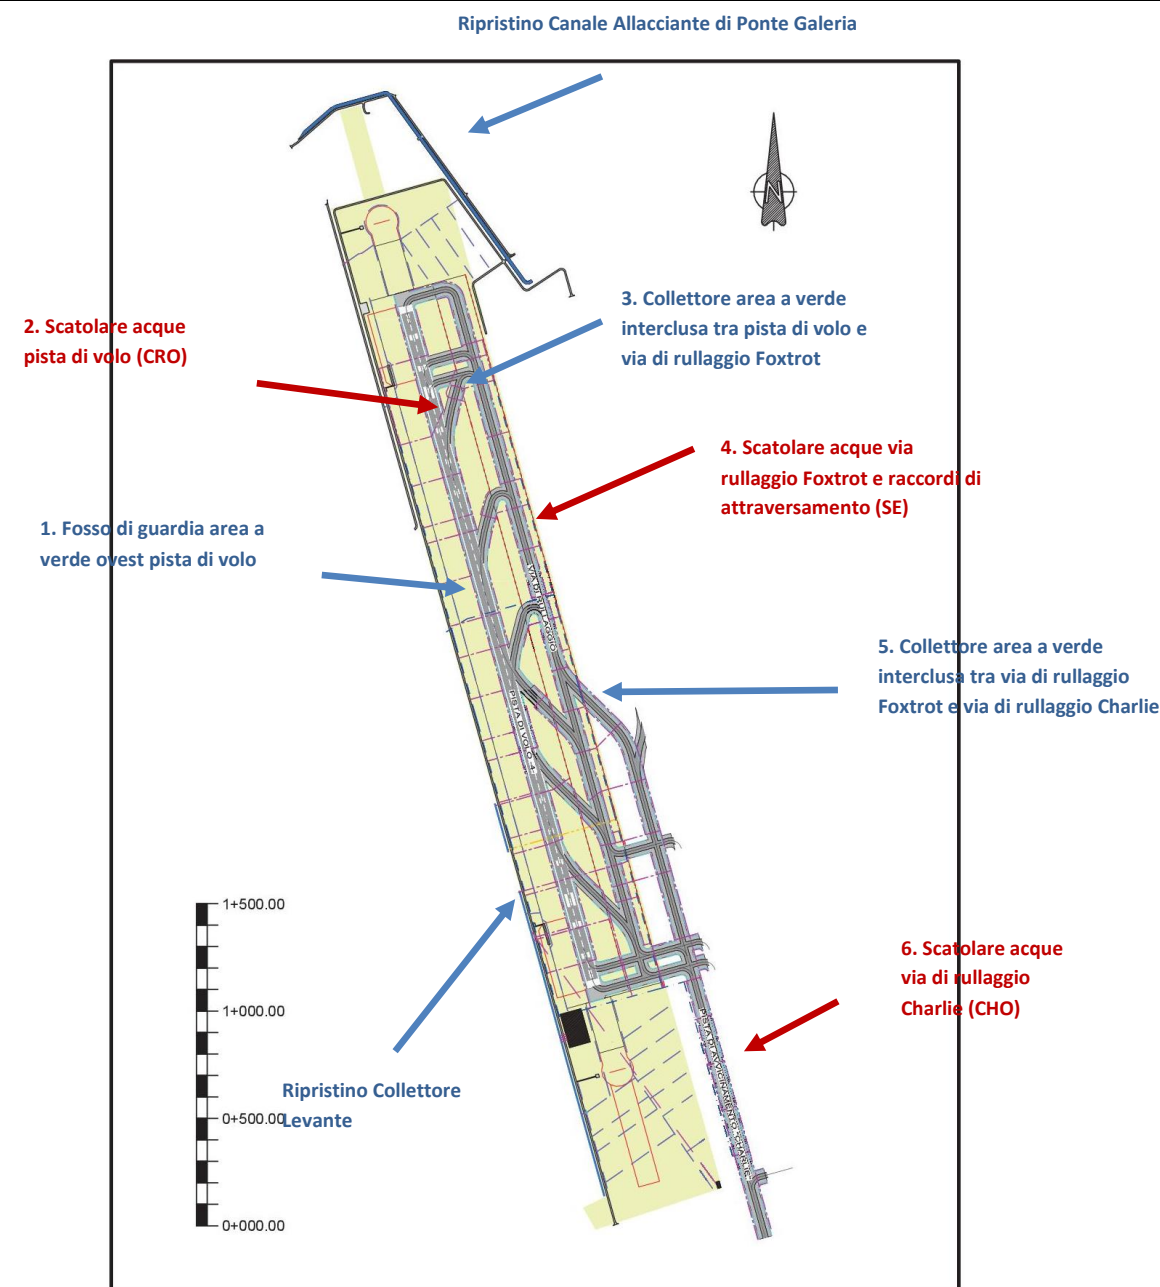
Planimetria del nuovo sistema di drenaggio.
